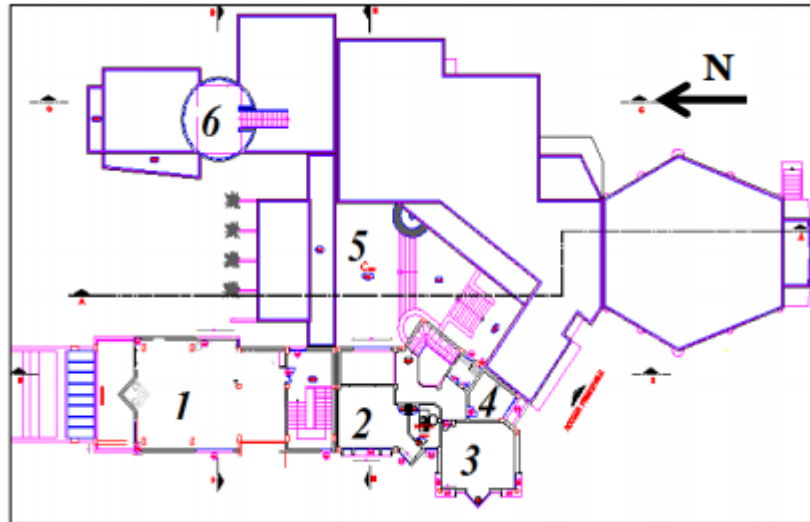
Le plan 1^{er} étage Source : dossier d'architecture du projet
